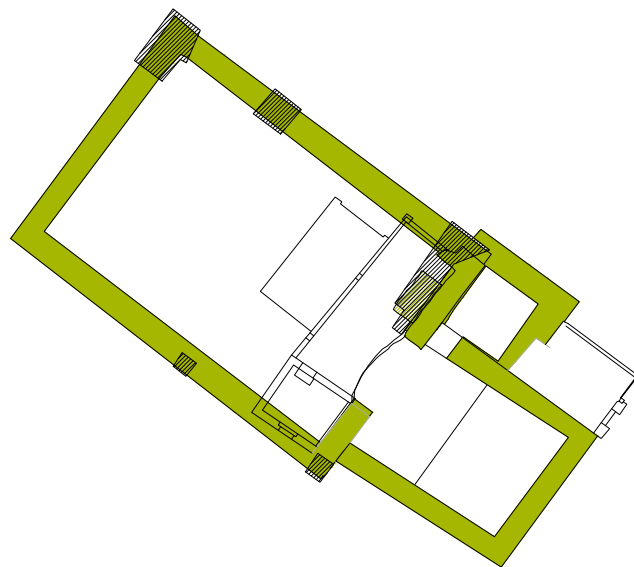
(ADB): Rekonstruierter Grundriss in Grün. Zu sehen ist links das Kapellenschiff für die Gläubigen, rechts der Chor mit angebaute Sakristei (für den Priester) und dem darauf viel-leicht aufgebauten Glockenturm (siehe auch Abb. 13 –18).
